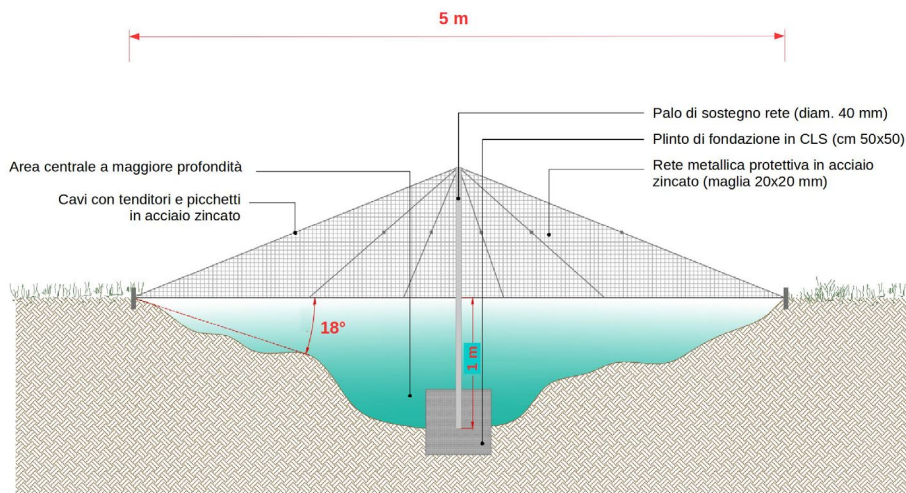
Sezione tipo di uno dei due stagni protetti dalla rete.
